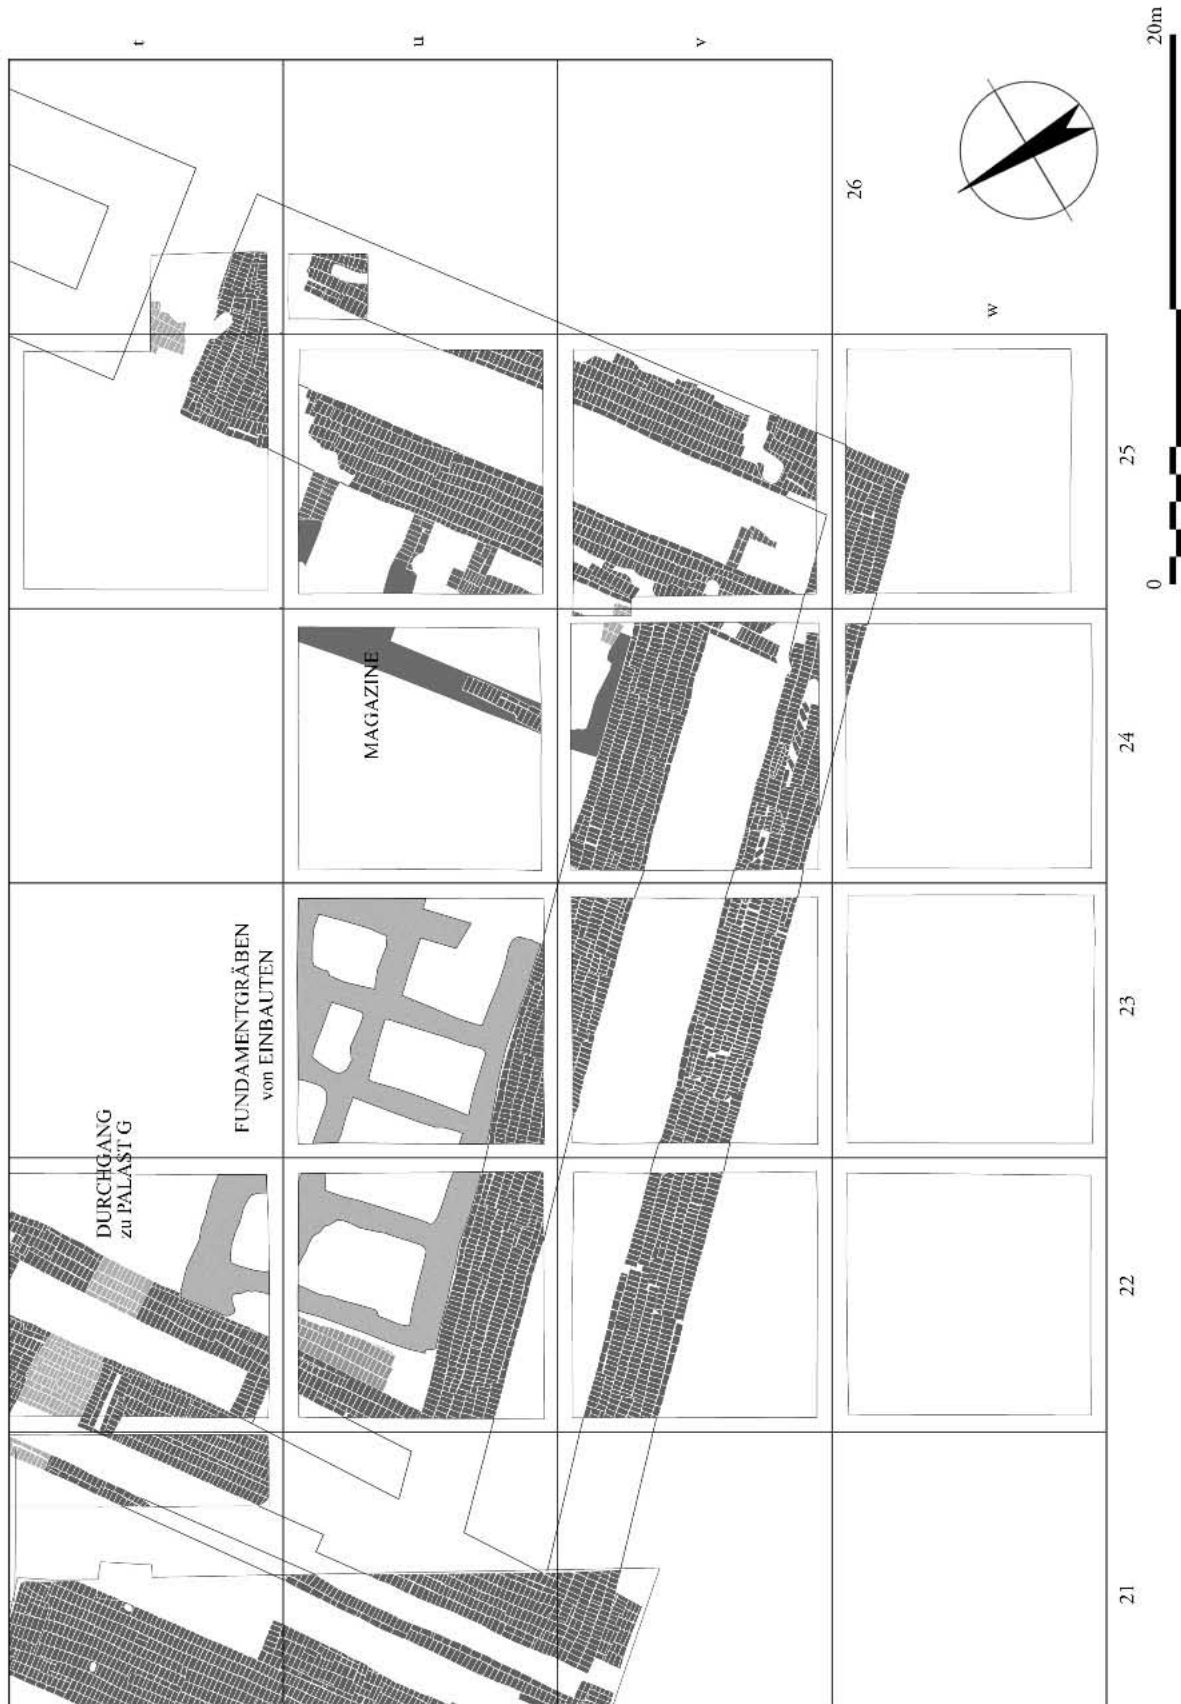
Plan des Gebäudes L mit den eingezeichneten nachträglich eingebauten 5 Kammersystemen
